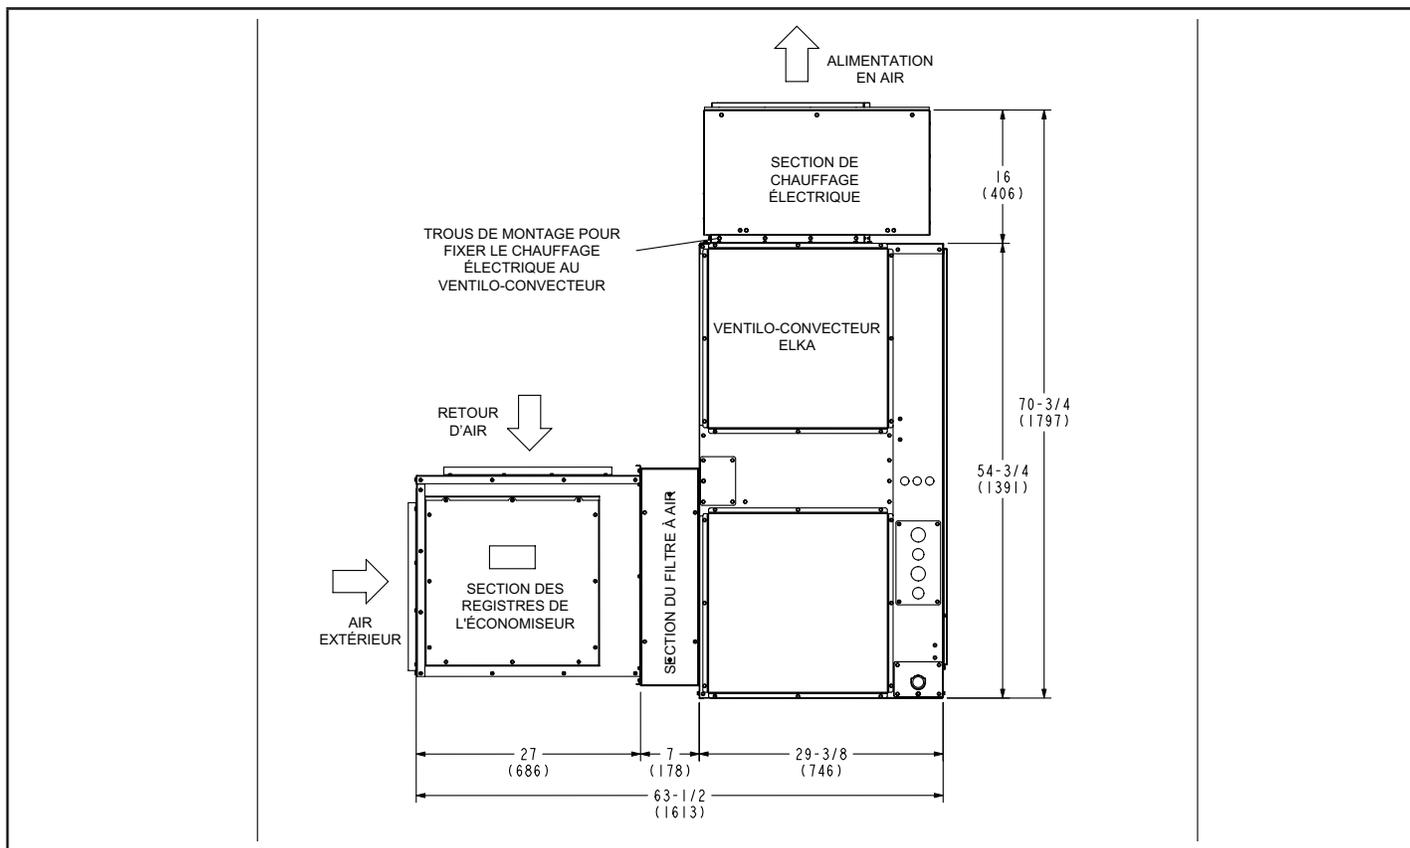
Configuration ascendante ELKA - dimensions - pouces (mm)
